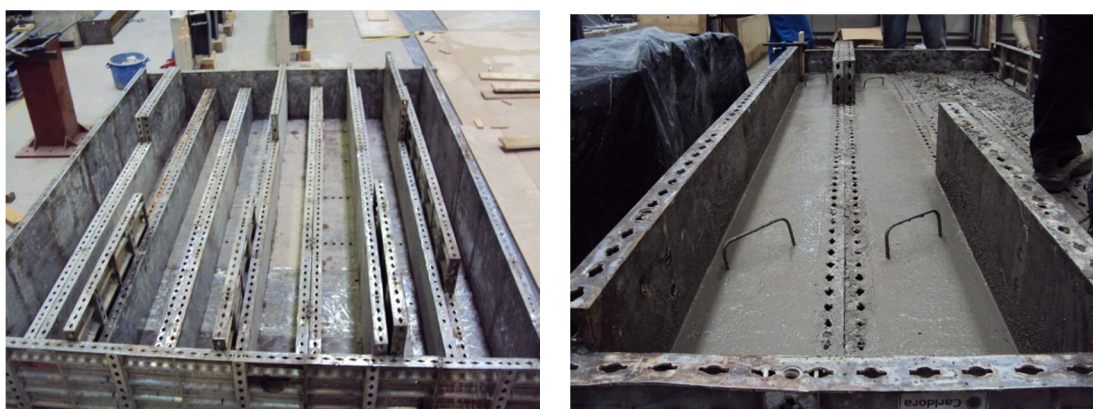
Vista geral das cofragens e betonagem das vigas.
